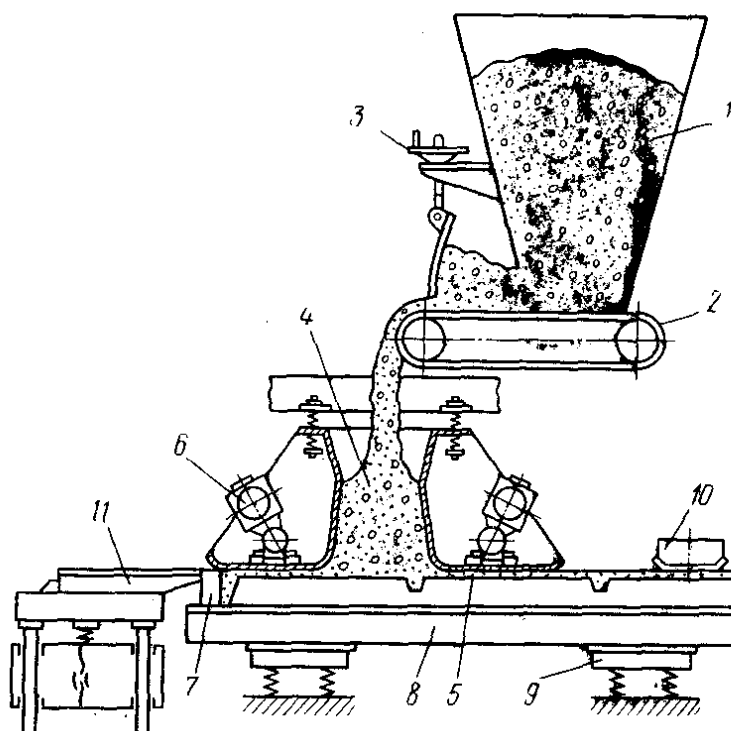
Схема формирования бетоноукладчиком с вибронасадкой:
